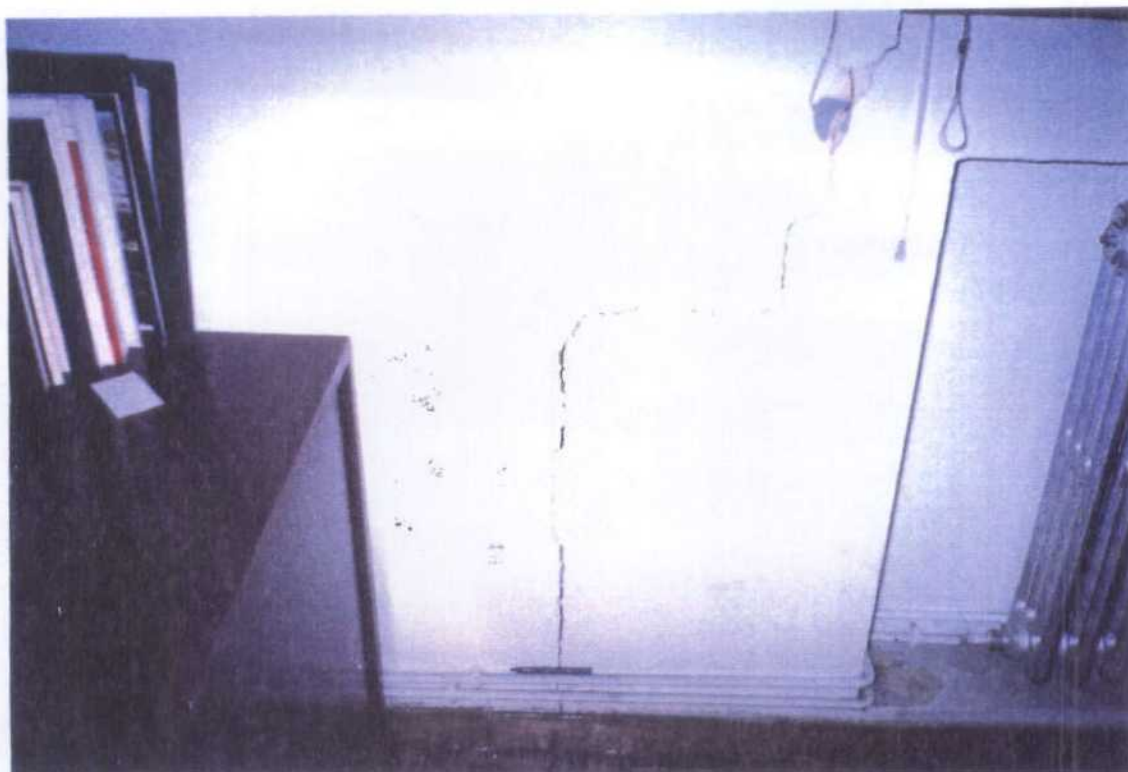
Agrietamiento en muro del edificio Oficinas de COFASA.
